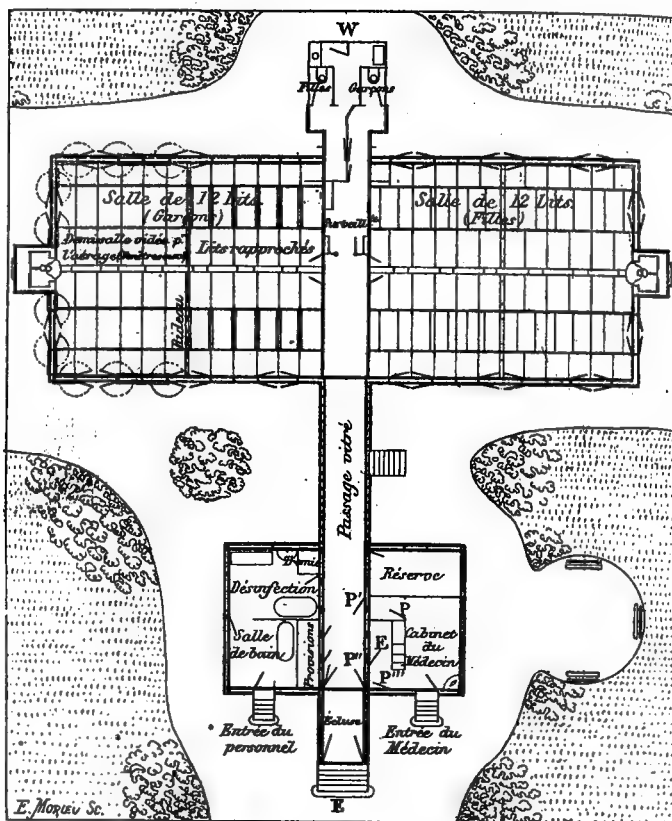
Plan d'un pavillon d'isolement à l'hôpital Trousseau et aux Enfants-Malades, construit par M. O. André.
